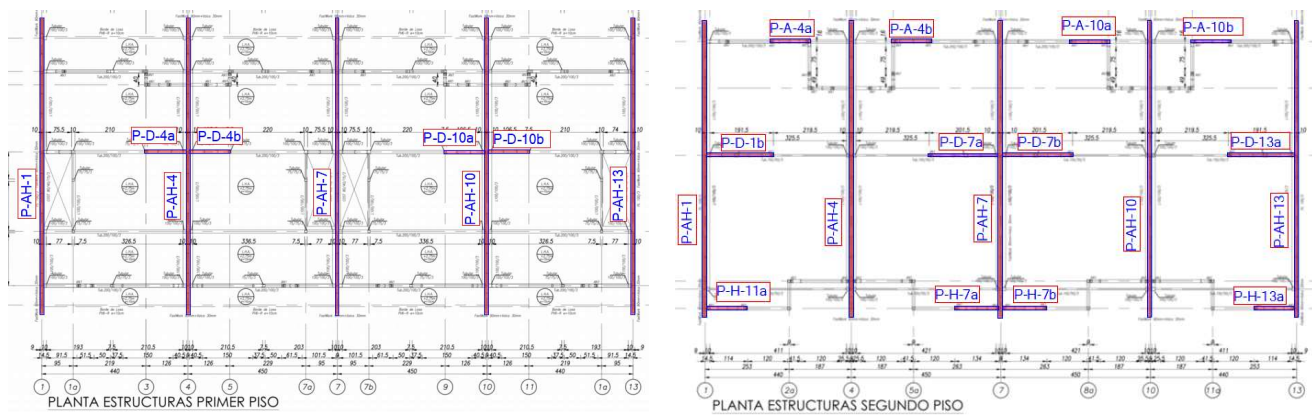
Figura XX. Planta cielo piso 1 y 2 notación de Pier
